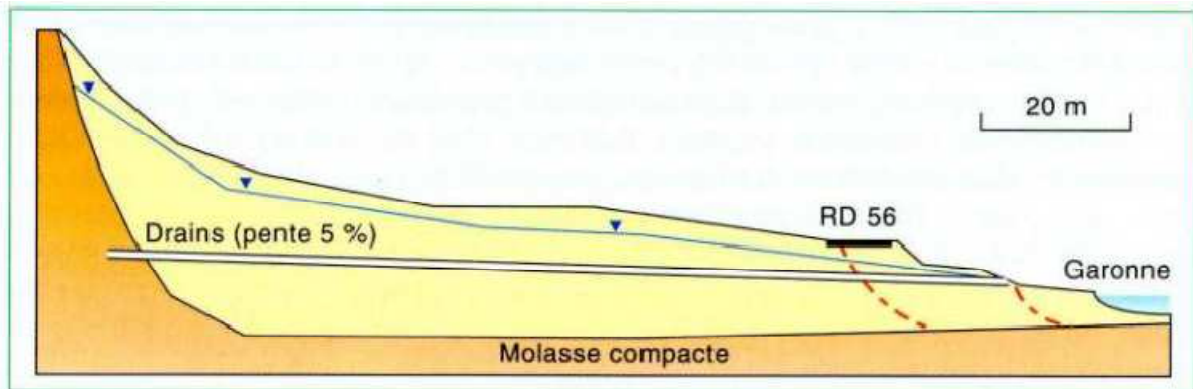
Drains subhorizontaux; Stabilisation de la RD 56 à Muret (France)
